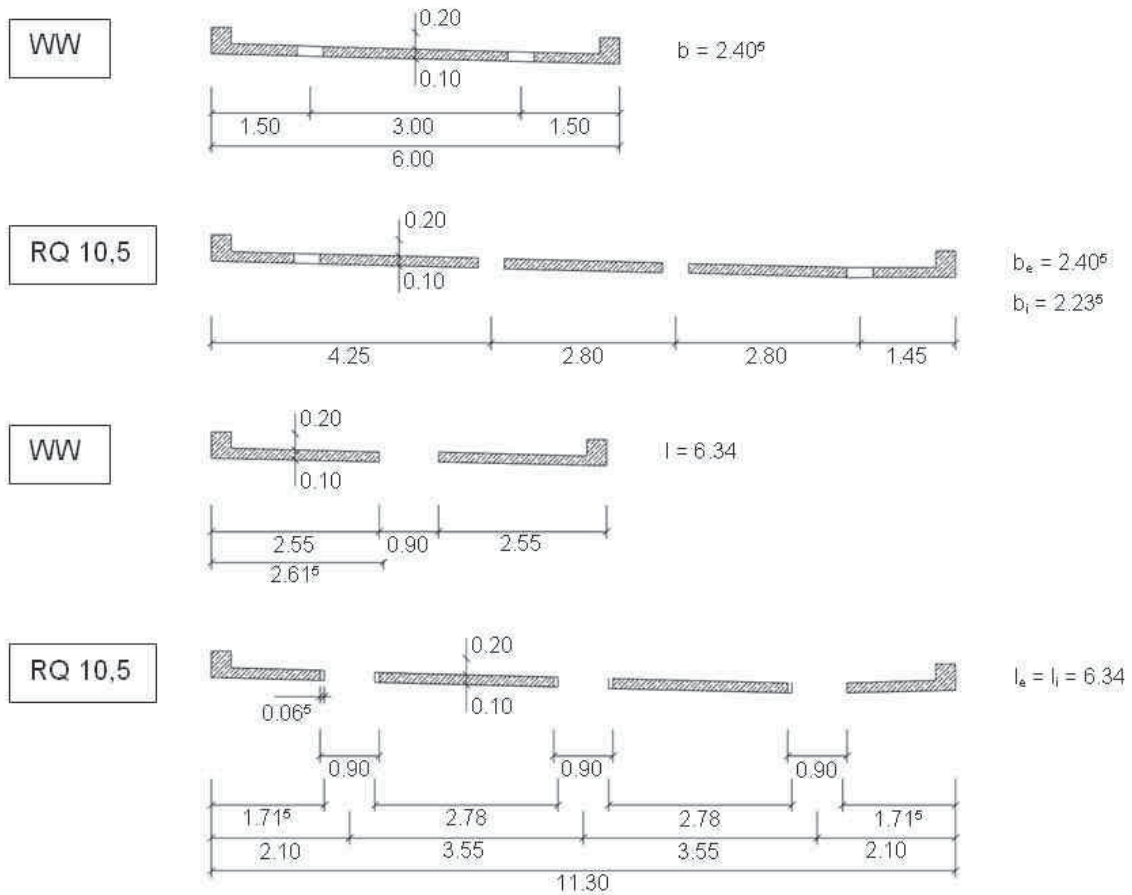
Exemples de sections transversales d'éléments de coffrage préfabriqués basés sur [81] pour les configurations de la Figure 2.42. Dimensions en (m).
